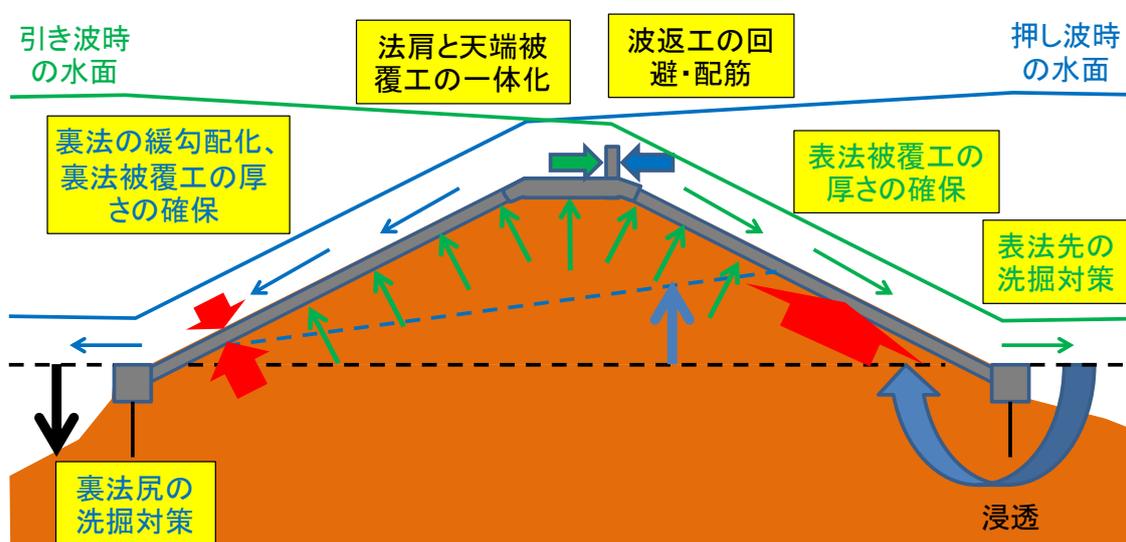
コンクリートブロック張式およびコンクリート被覆式に共通する現象への対処
